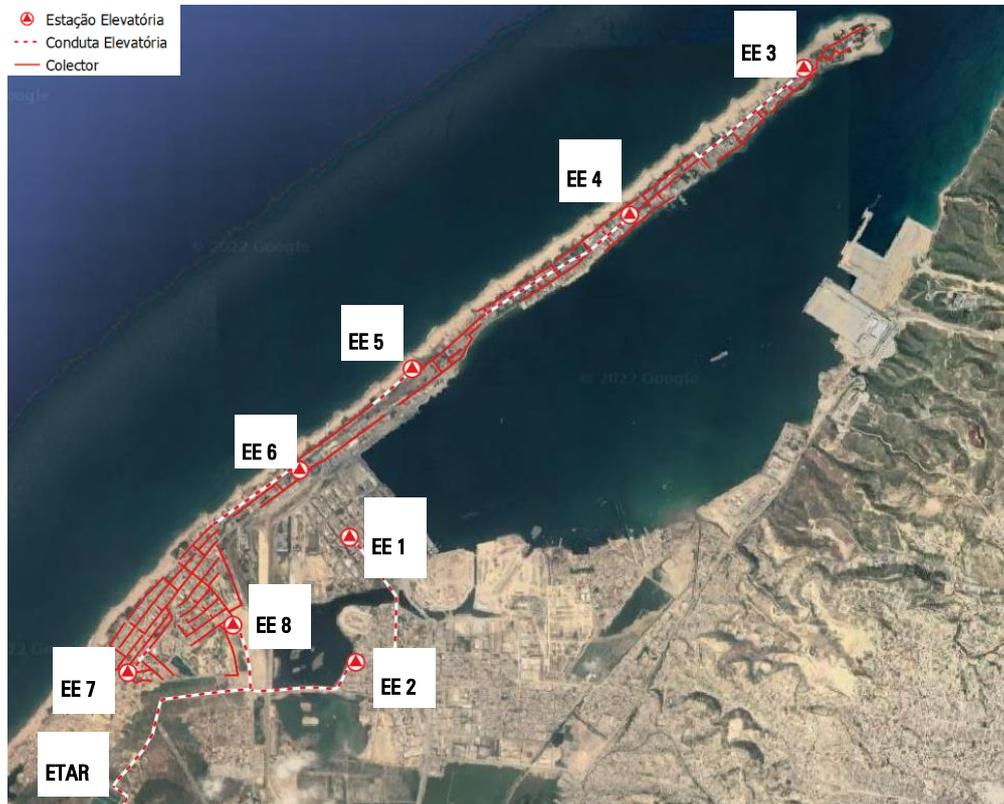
Representação esquemática das infra-estruturas de drenagem previstas: Restinga, Compão, Académico e Comercial (Planta 1/3)
